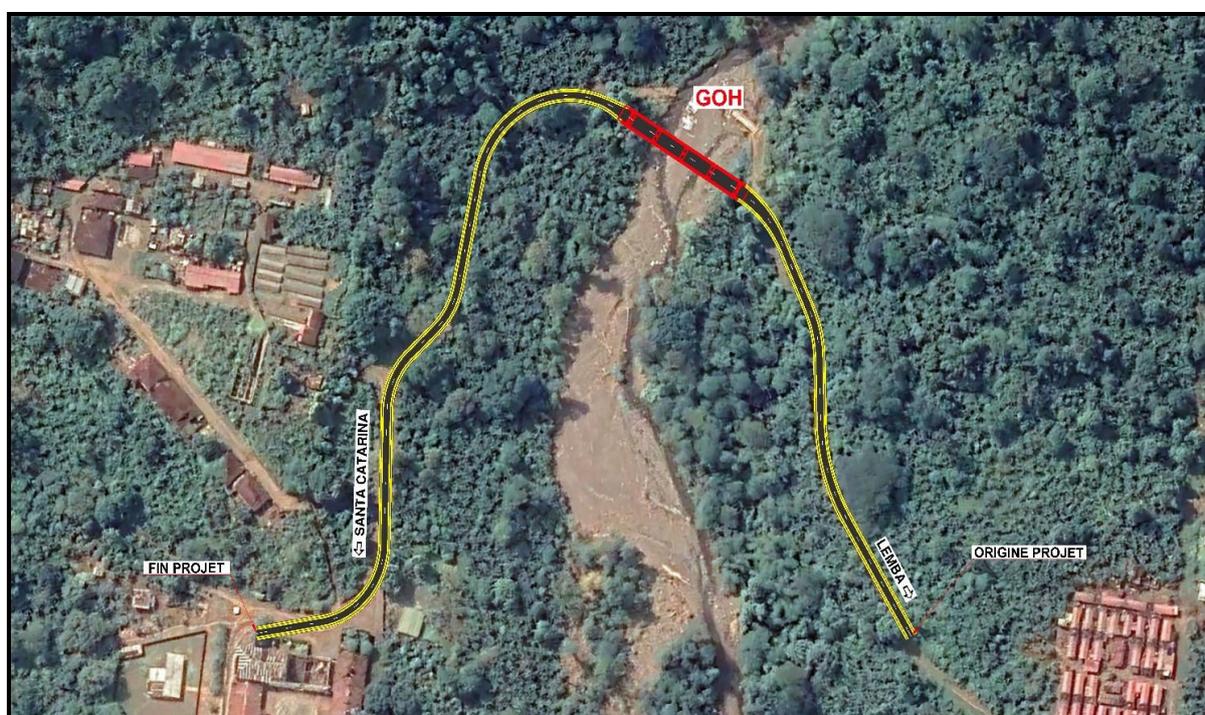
Traçado da estrada de ligação na ponte de Brigoma
